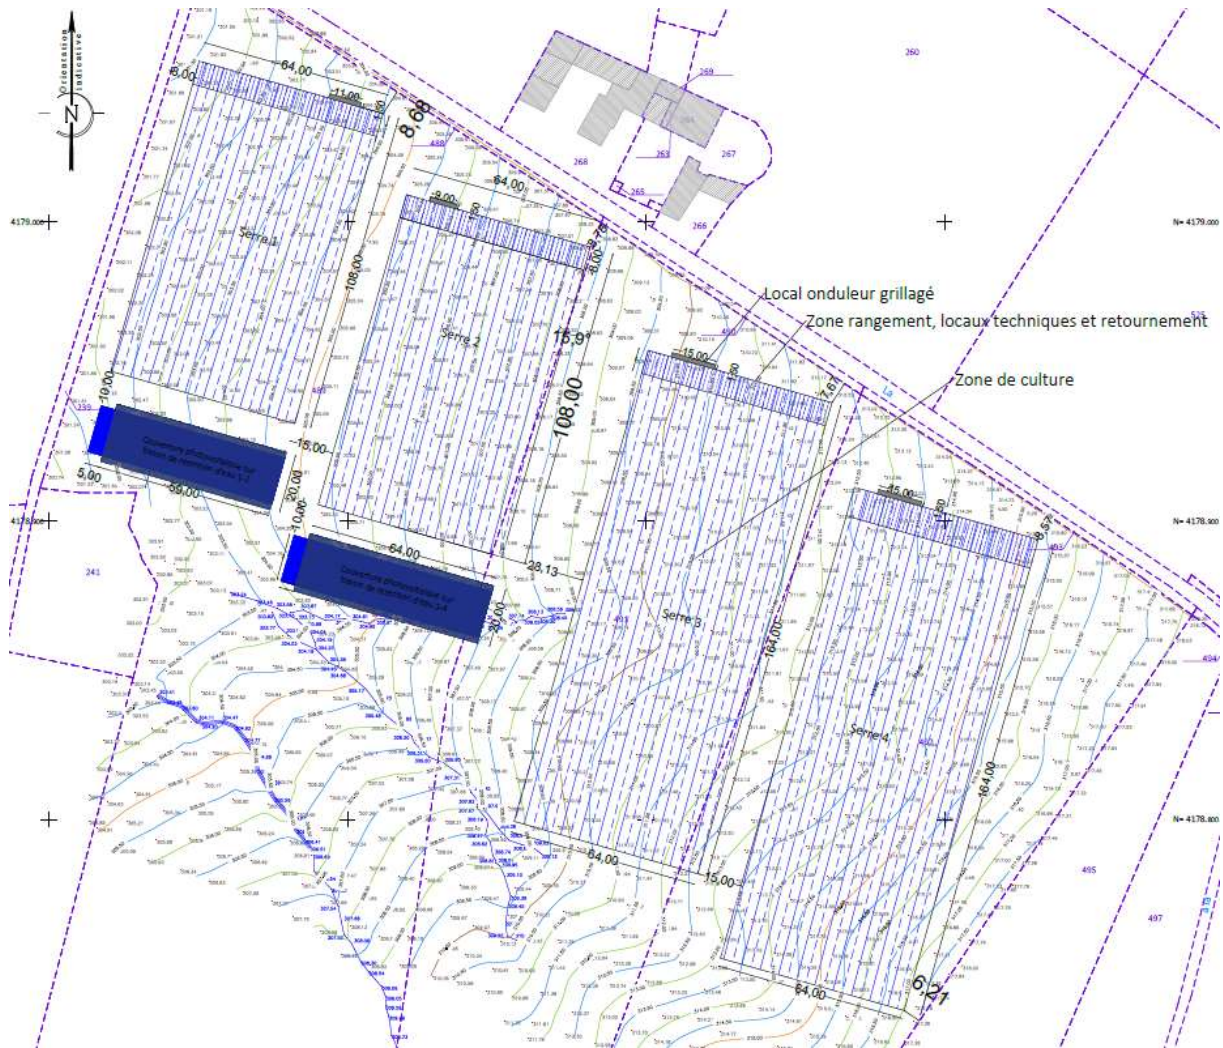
Plan d'implantation des serres photovoltaïques sur le terrain de M. Gasquet
